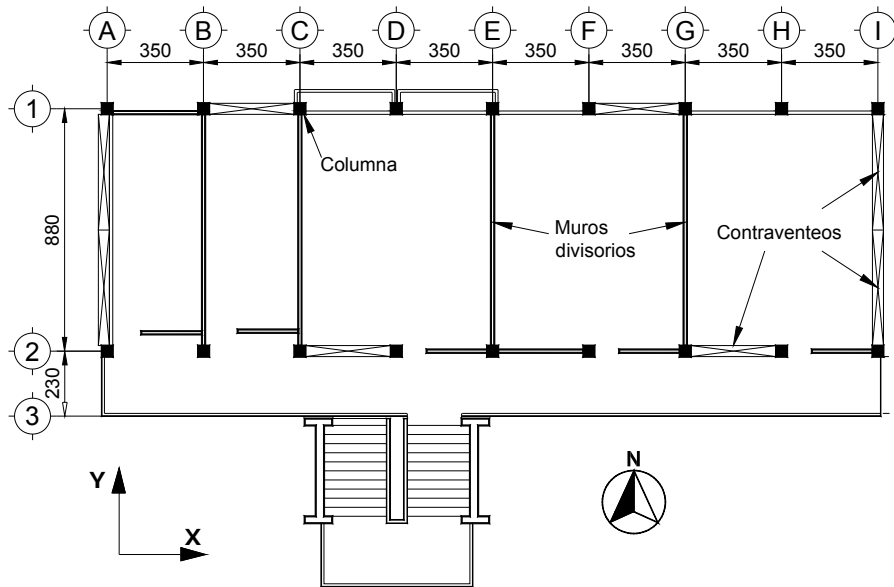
Ejemplo de croquis planta tipo de un edificio
